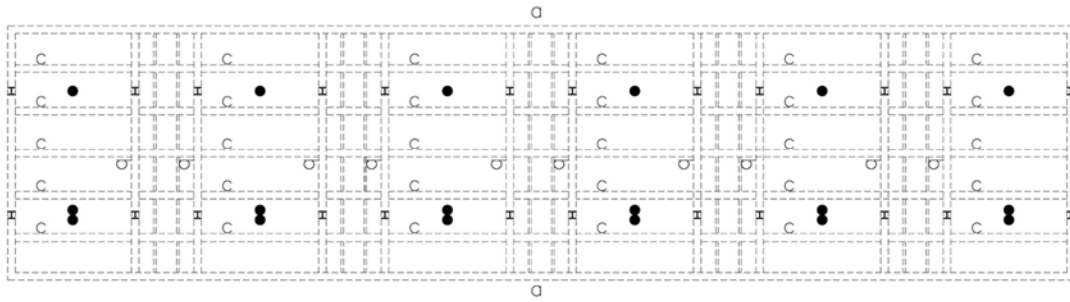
Lançamento de pilares e vigas da plataforma metálica.
